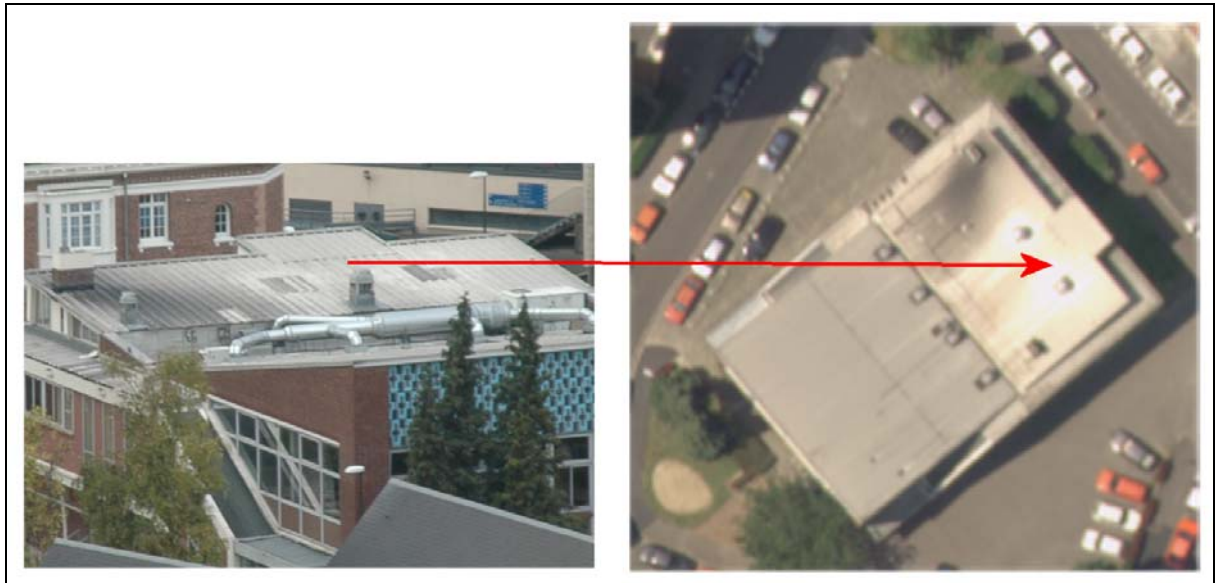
Toits à faible pente faisant apparaître les « joints debout ».
